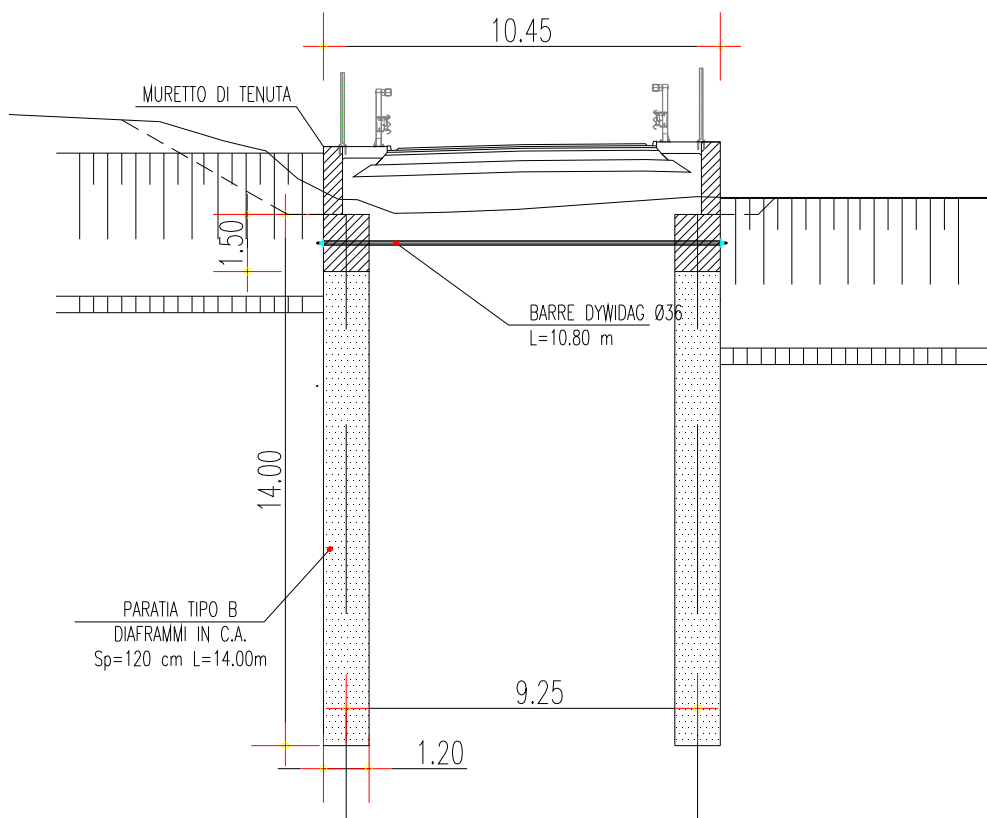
Sezione trasversale in corrispondenza delle paratie di risvolto
